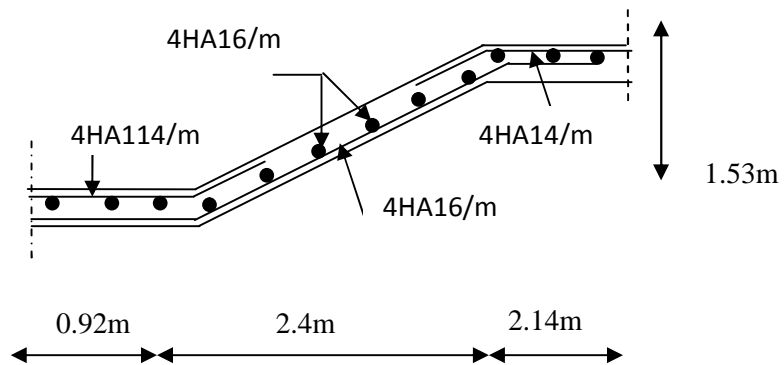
Schéma de ferrailage de la 1^{ère} et la 2^{ème} volée d'escaliers EC
